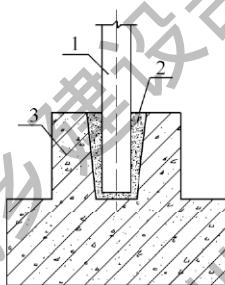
预制钢筋混凝土柱或插入式柱脚灌浆
